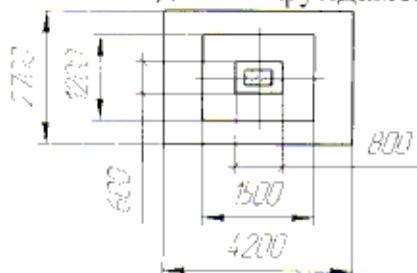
Фундамент под колонны серии КЭ-01-49
